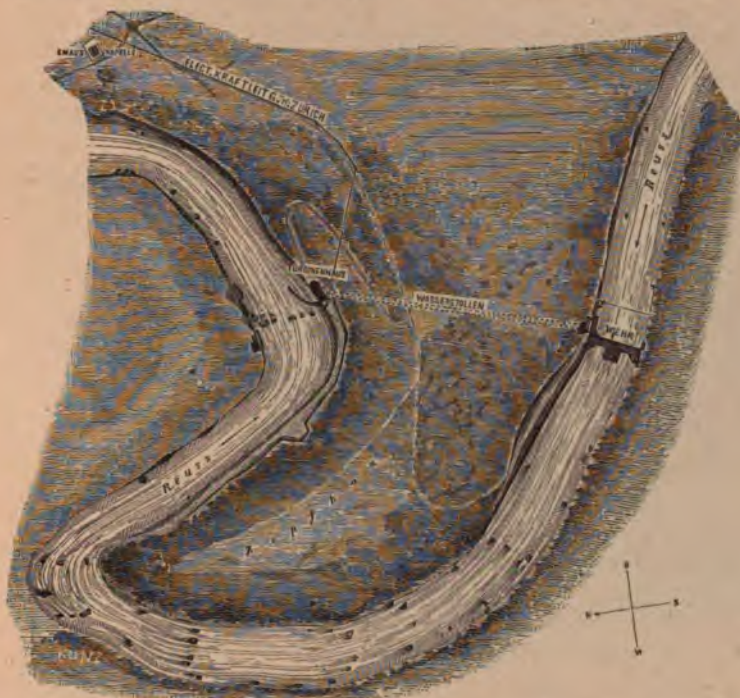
Vue en plan de l'installation hydraulique. — Échelle 1/10000.
